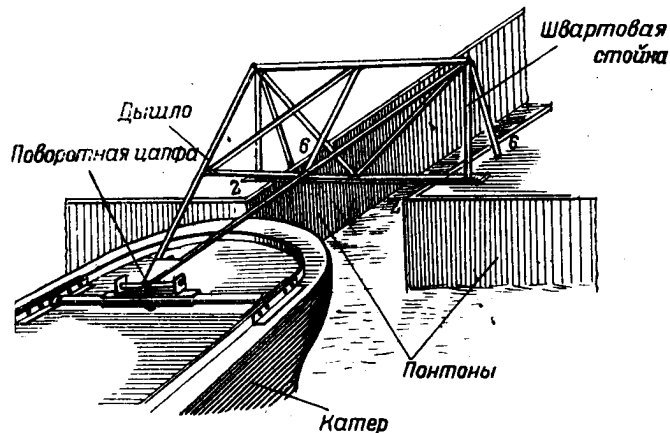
Крепление приспособления для толкания к парому и катеру.
